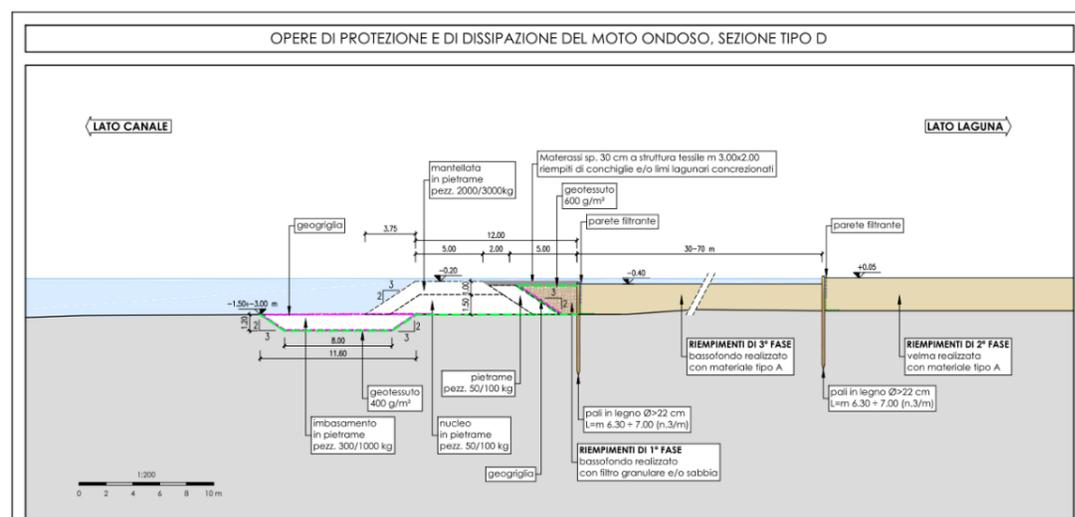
opere di protezione e dissipazione sezione tipo D
